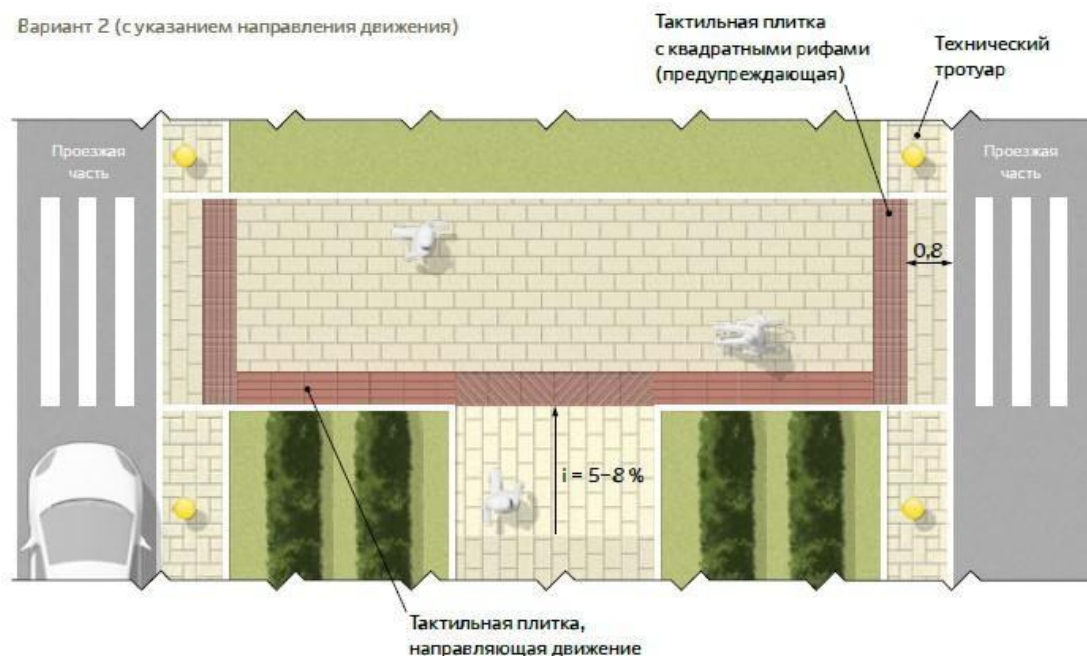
Размещение тактильных плит на пешеходных тротуарах, расположенных на уровне проезжей части (вариант 1,2)
